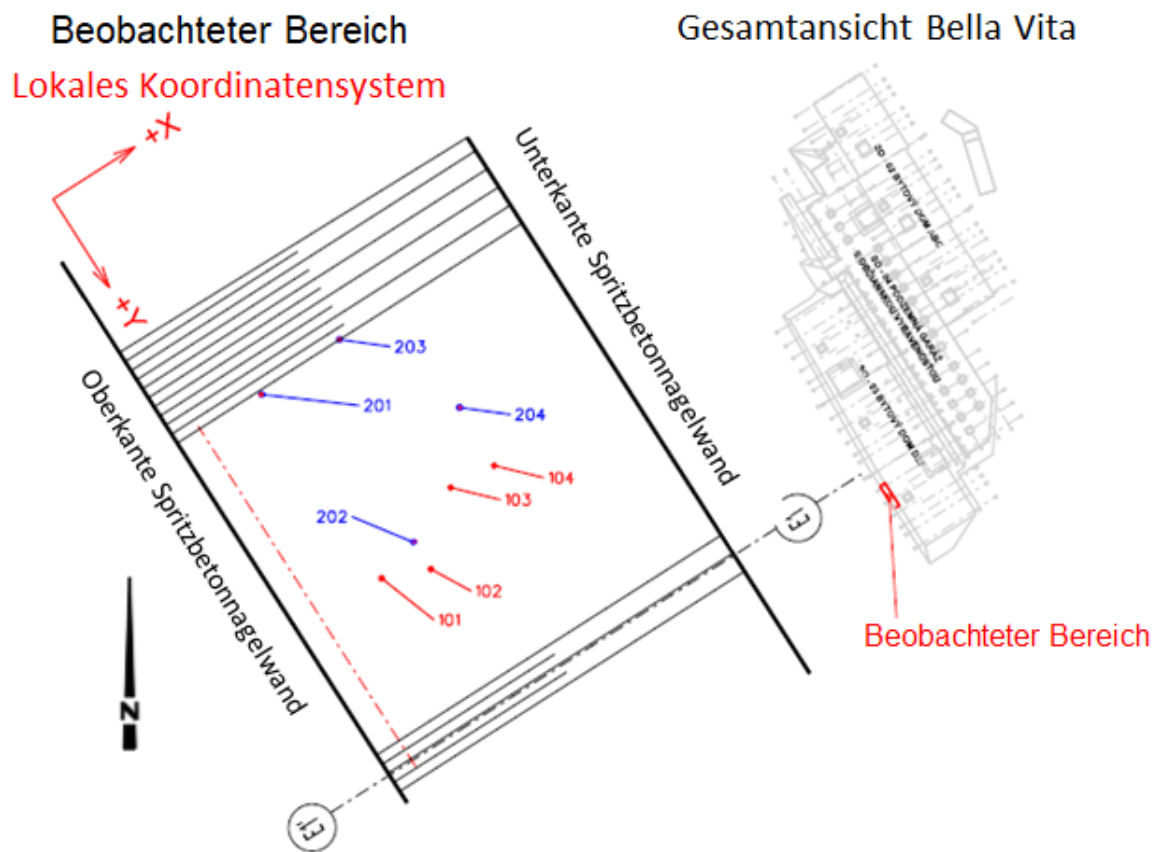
Position und Nummerierung der Messpunkte im Grundriss [18]
